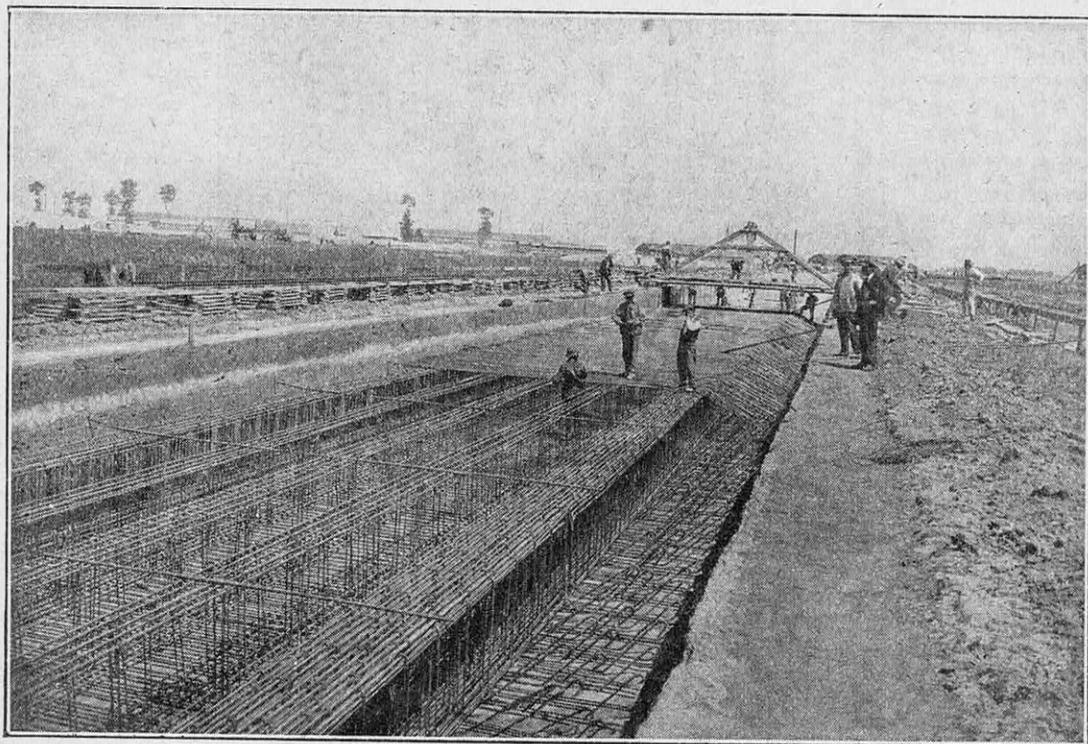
CONSTRUCTION D'UNE FONDATION SERVANT DE POINT D'APPUI A LA VOÛTE
